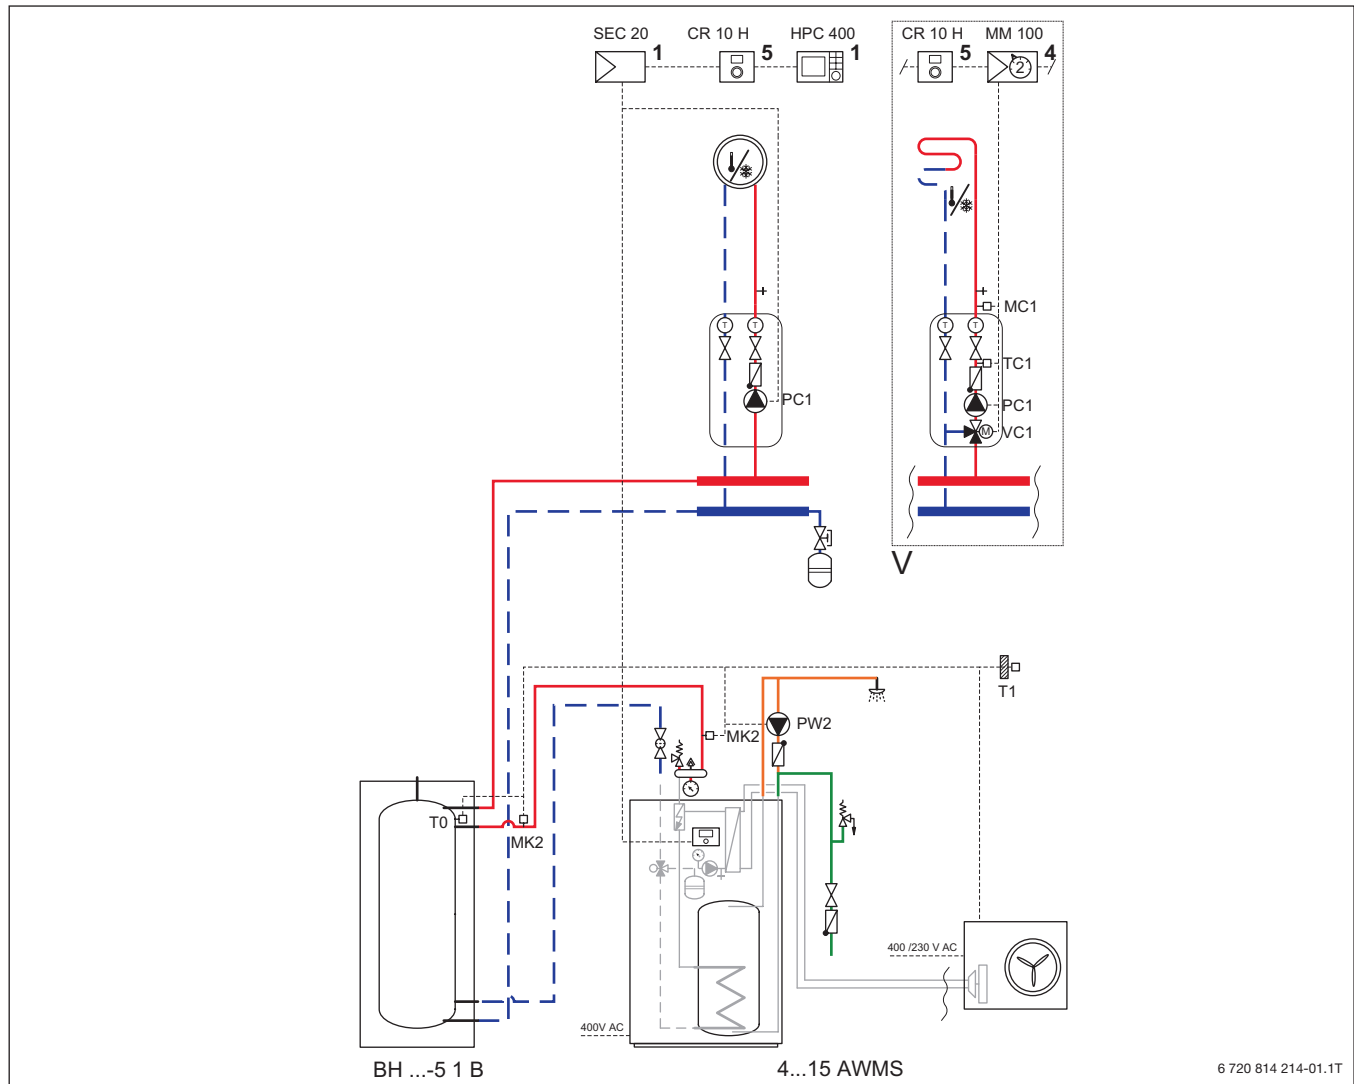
Принципова схема опалювальної установки з приладами керування (необов'язкова схема)
